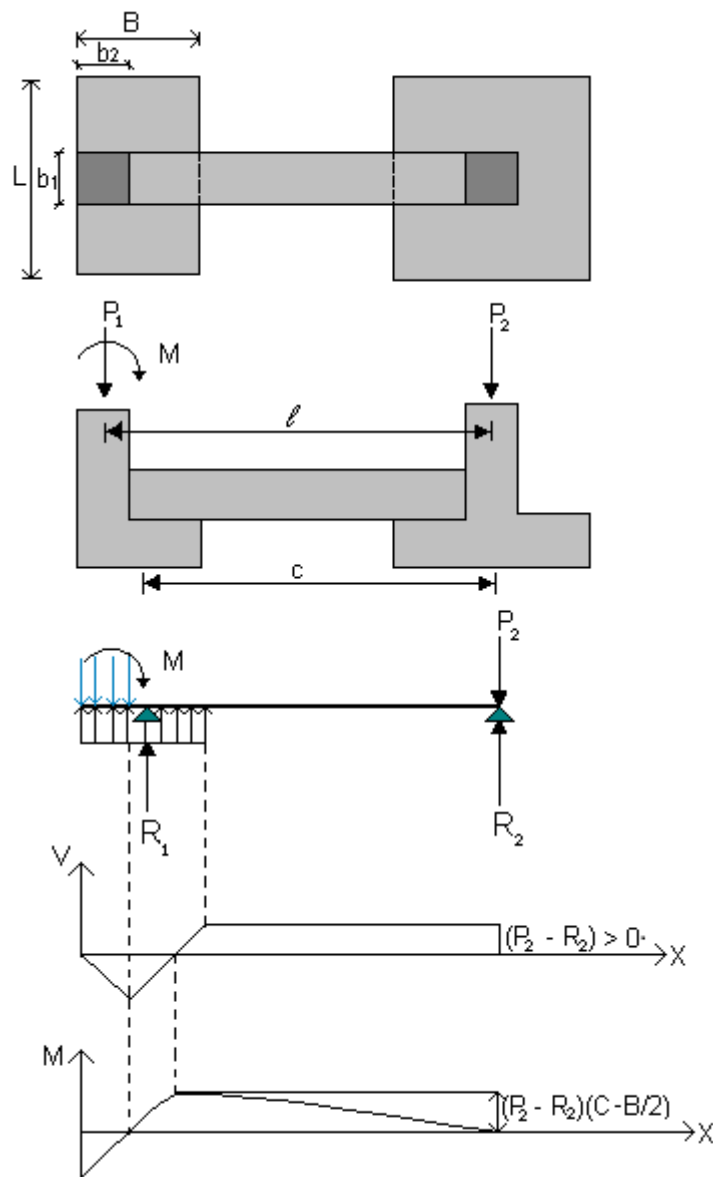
Geometría y Modelo Estructural de la Zapata Enlazada
